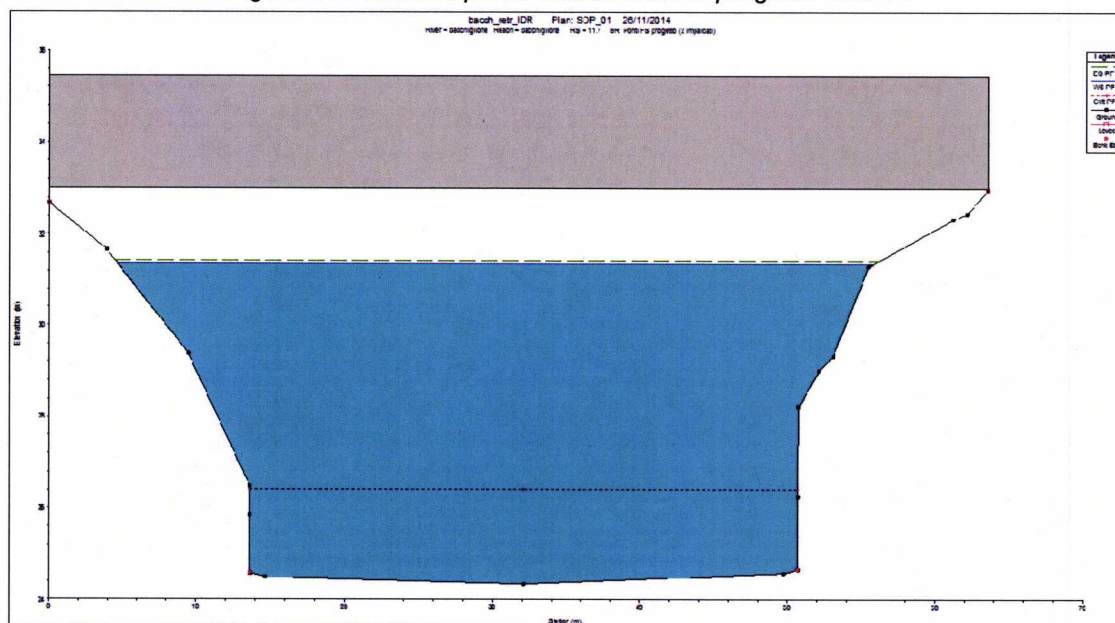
Sezione nuovo ponte stato di progetto SDP1.
